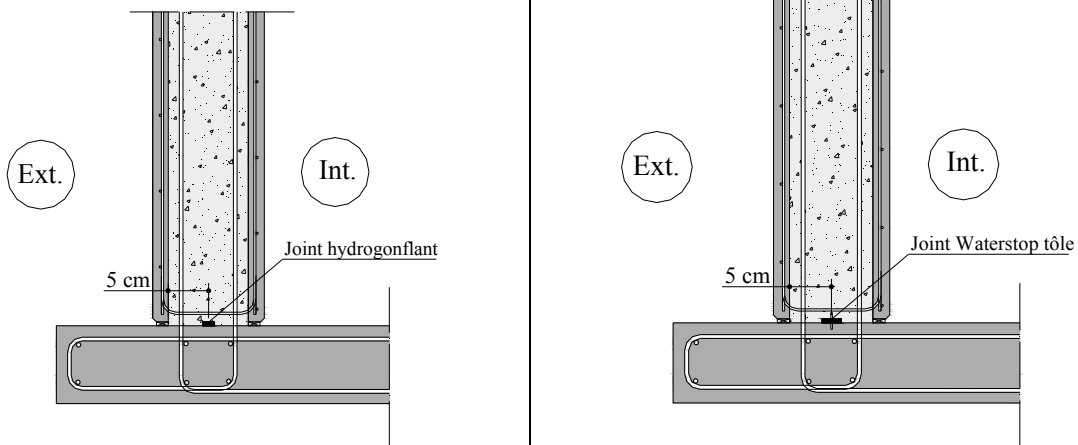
Etanchéité d'un mur d'épaisseur 25 cm
